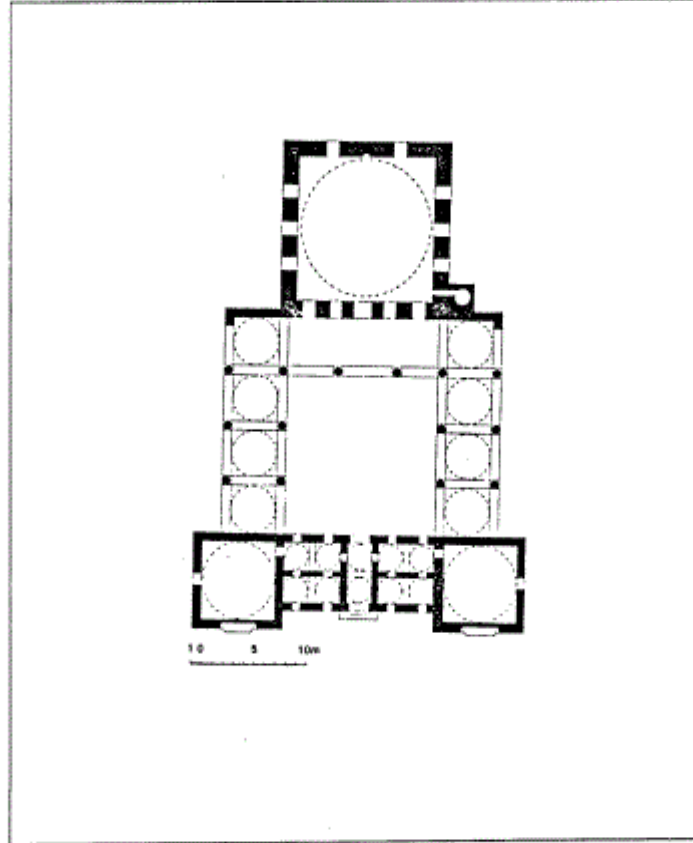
مسقط أفقي لمجمع السليمية في أدرنة (عن: Cezar).
